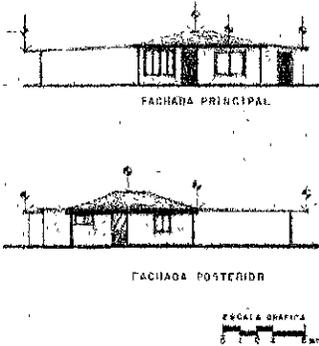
Fachada Norte (principal) y Sur (posterior), caso 15.
